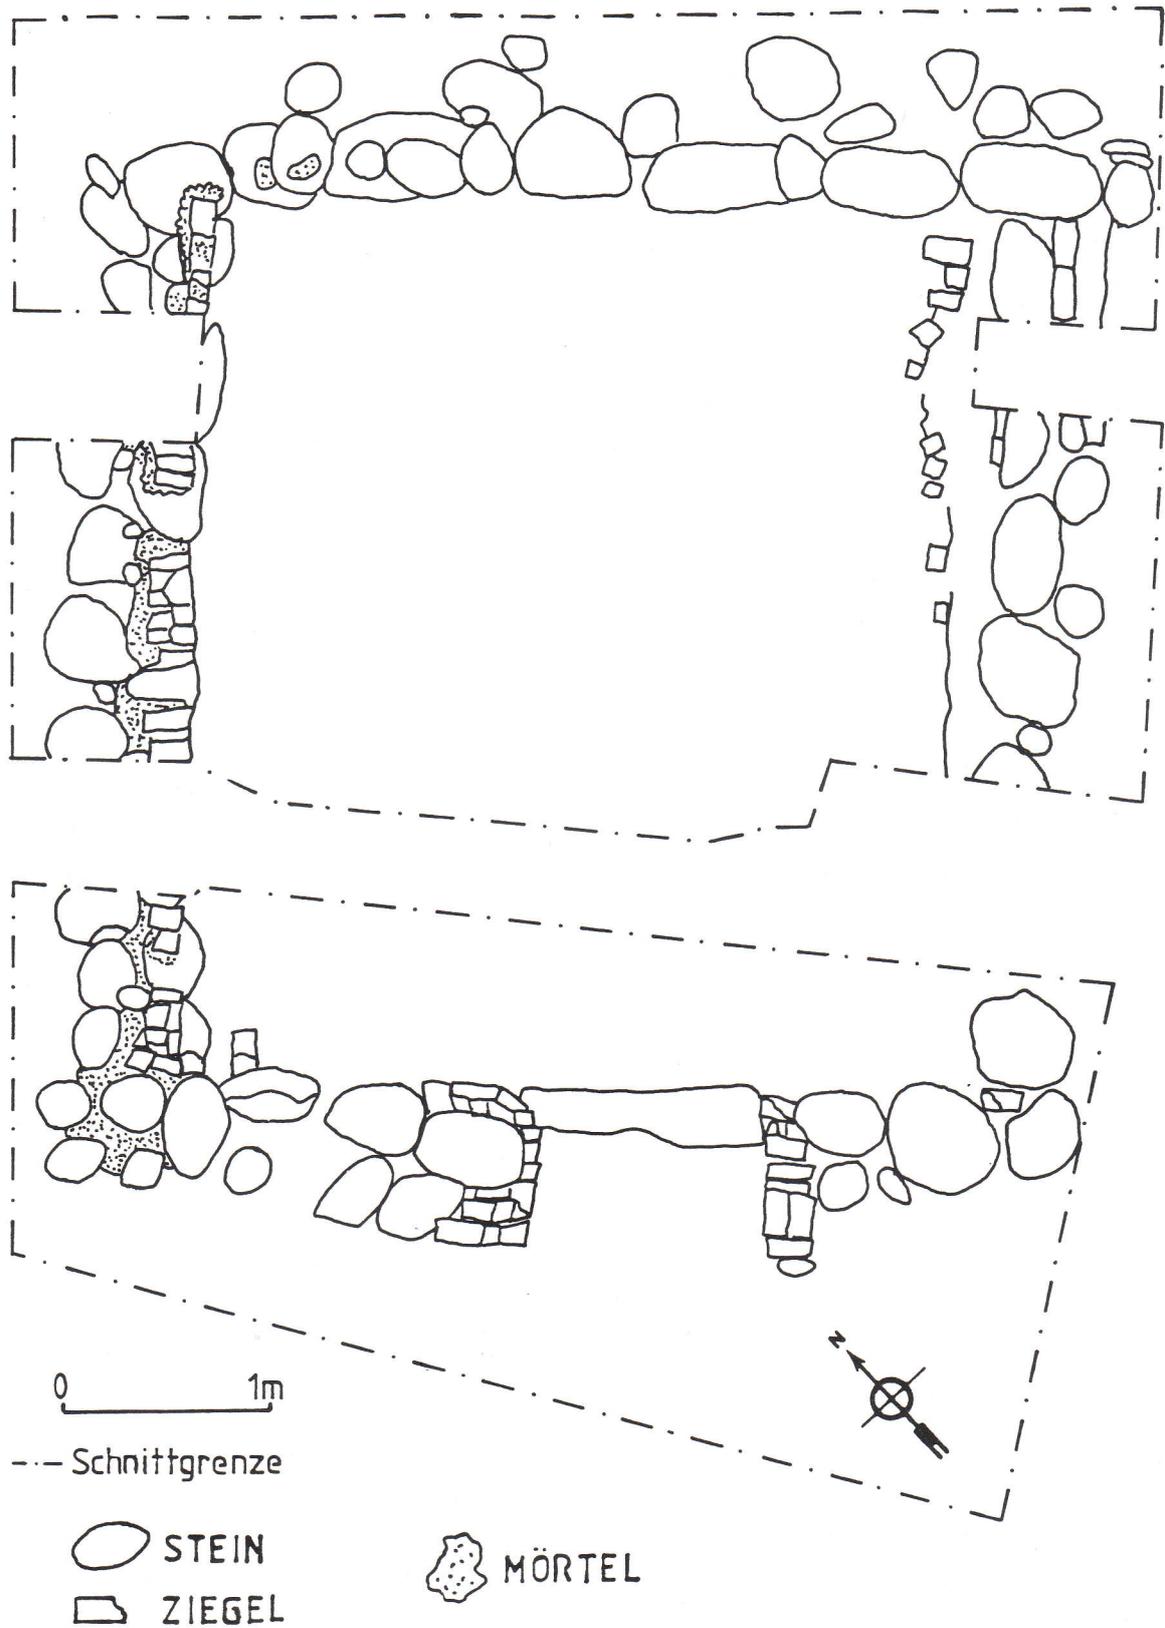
Grundriß des Findlingsfundaments, Maßstab 1:50.
